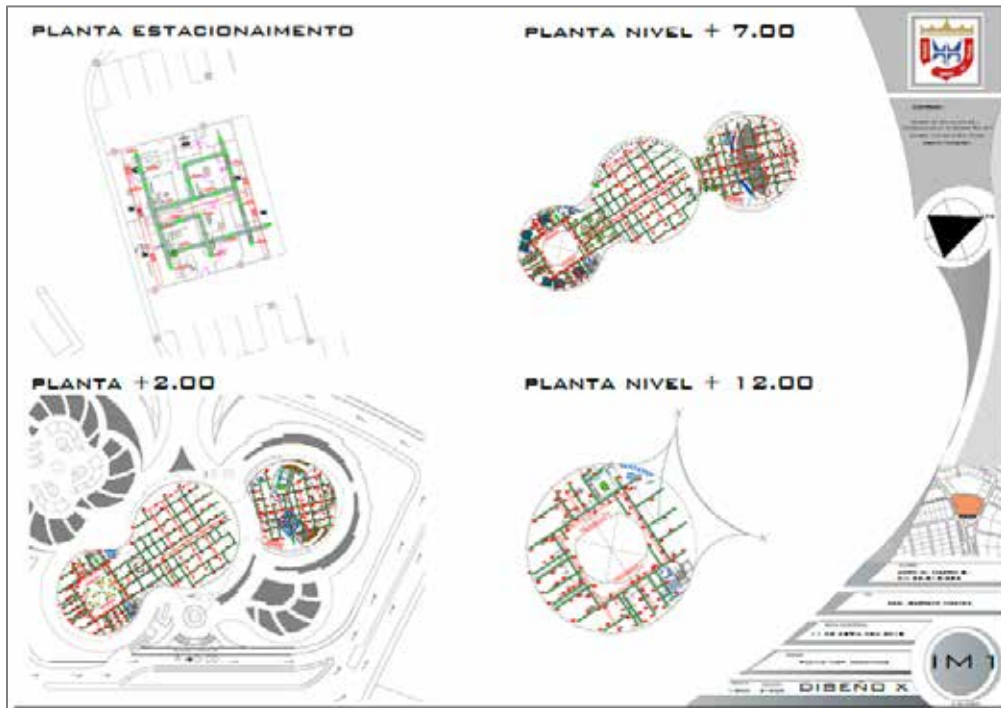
Planos Inst. Mecanicas – Aire Acondicionado (2018)
